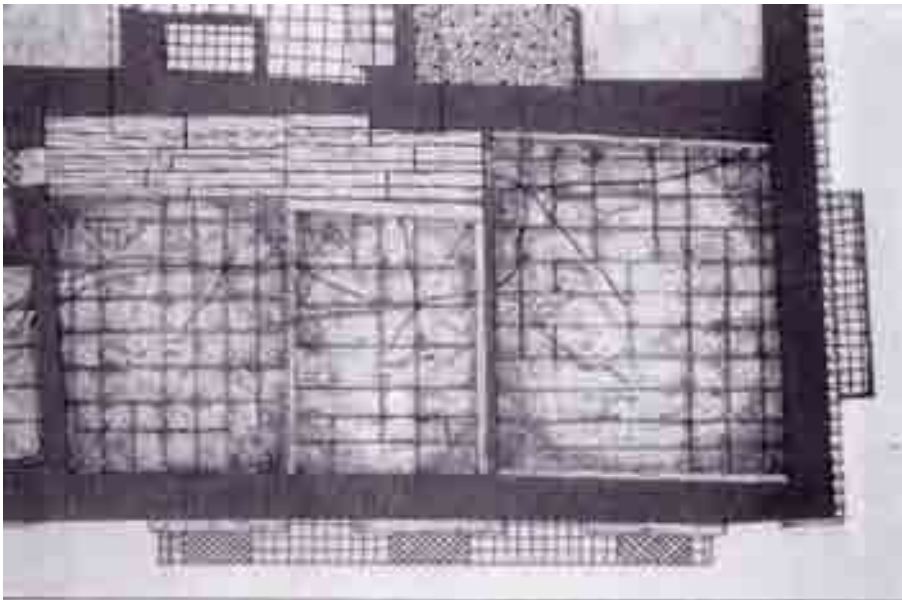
Palazzolo Acreide, particolare planimetrico delle pavimentazioni
